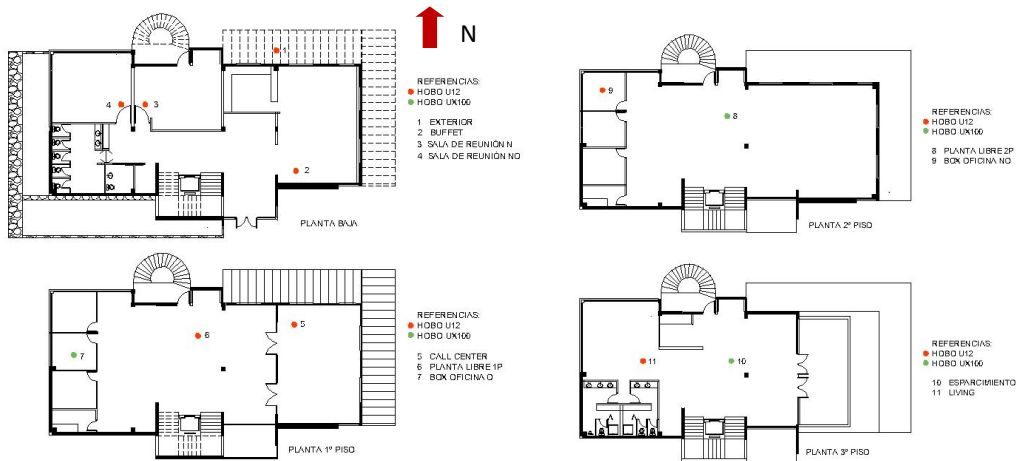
Ubicación en planta arquitectónica de instrumental de medición por sectores y niveles sin escala. Fuente: elaboración propia.
